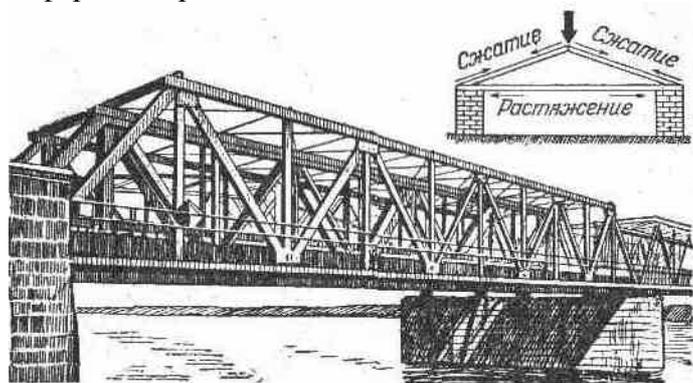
Простейшая ферма и ферма железнодорожного моста.
